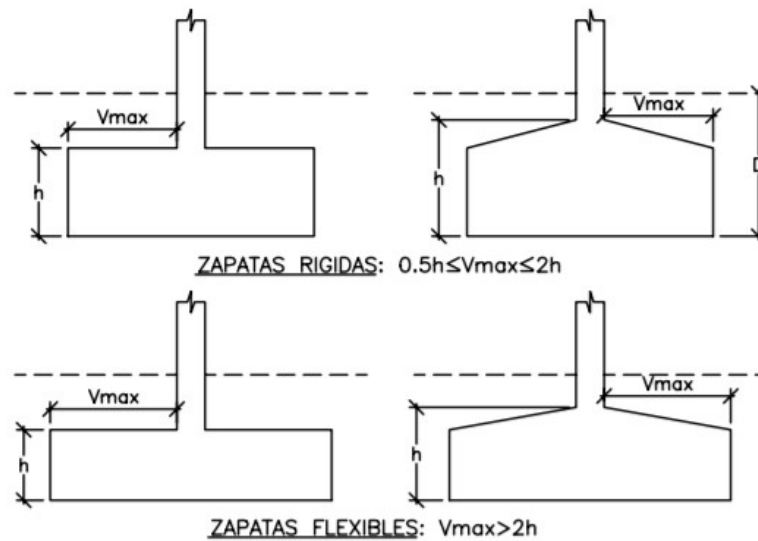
Clasificación de las zapatas según EHE ^[3]
